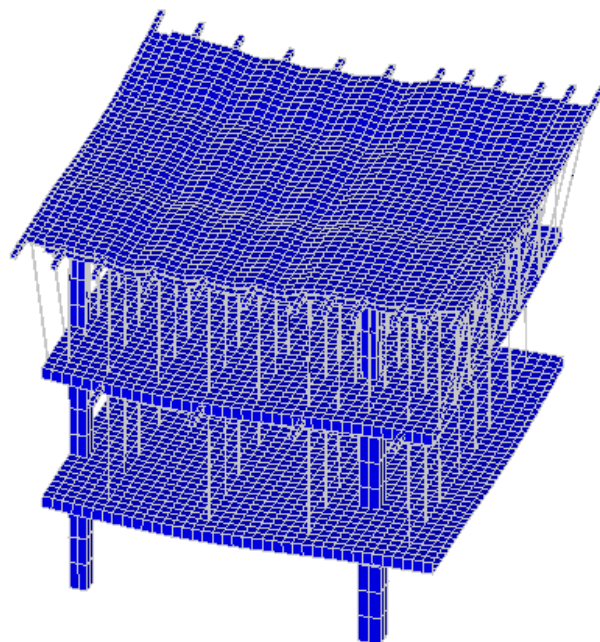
Deformada tipo. Paso de carga 6 (Hormigonado del forjado 3)
